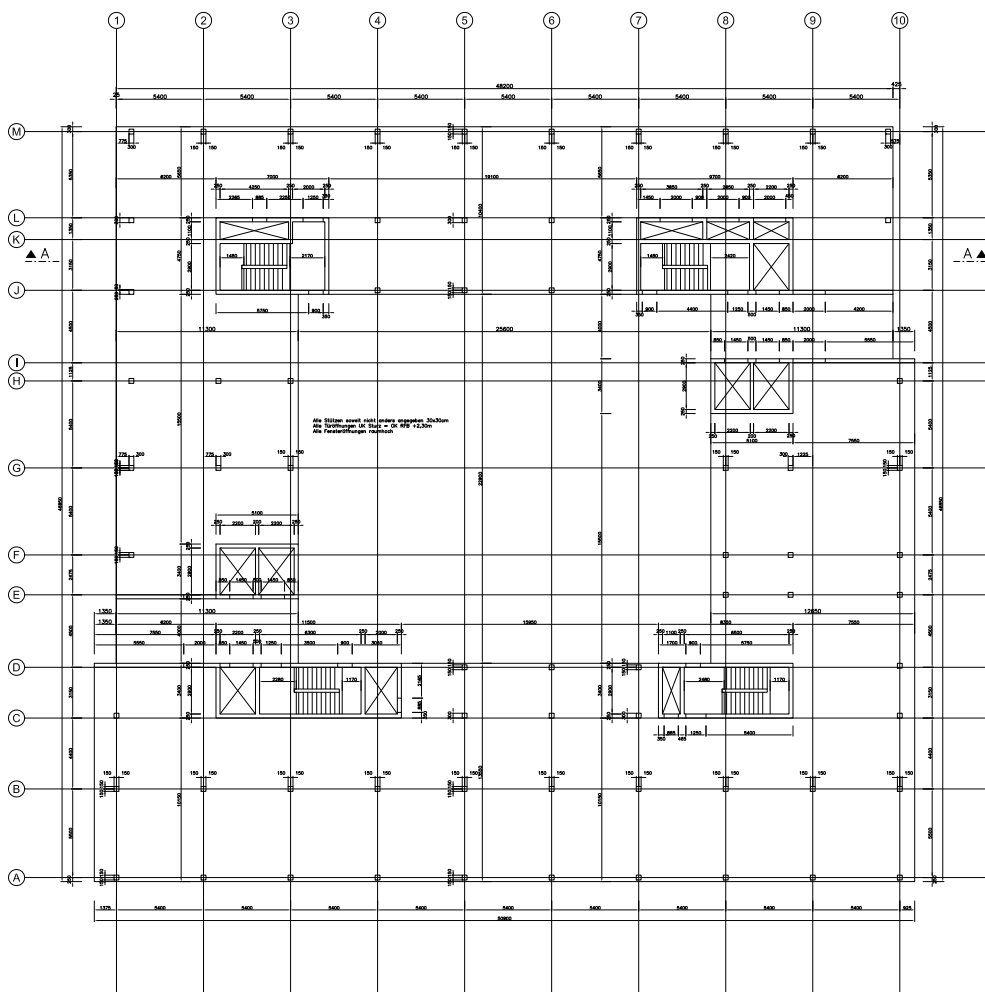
Grundriss – Regelgeschoss (Doka)
